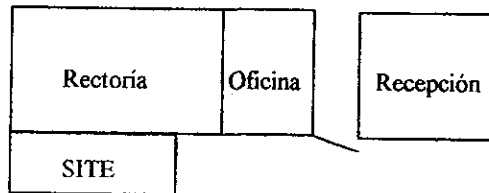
Croquis del edificio de Rectoría (Vista de planta)
